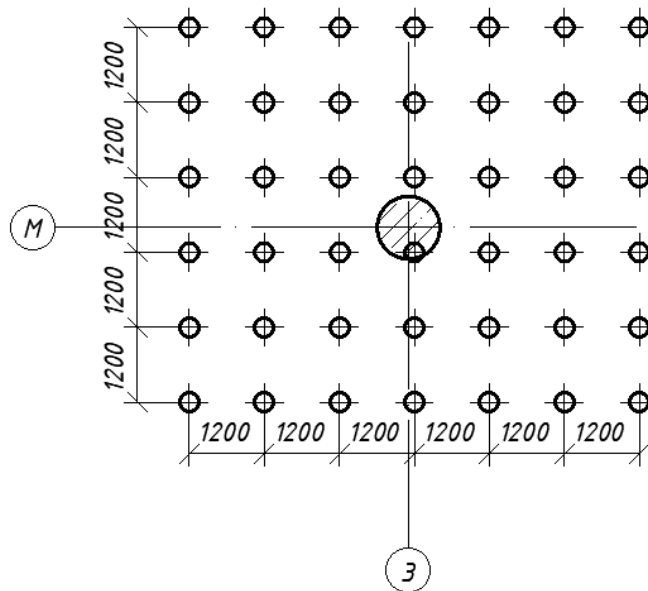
Схема расположения свай под фрагмент плитного фундамента
